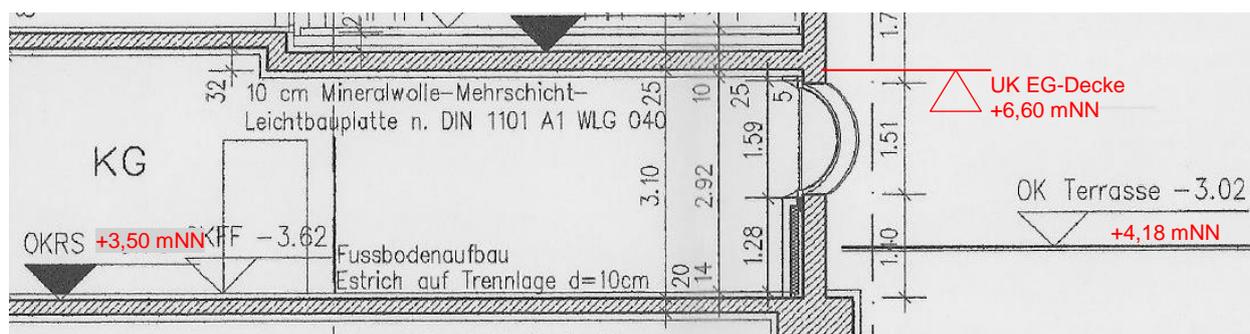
Schnitt Achse 20 des unterkellerten Bereichs – Ausschnitt aus dem Plan 533 (Stand: 12.03.2001)
